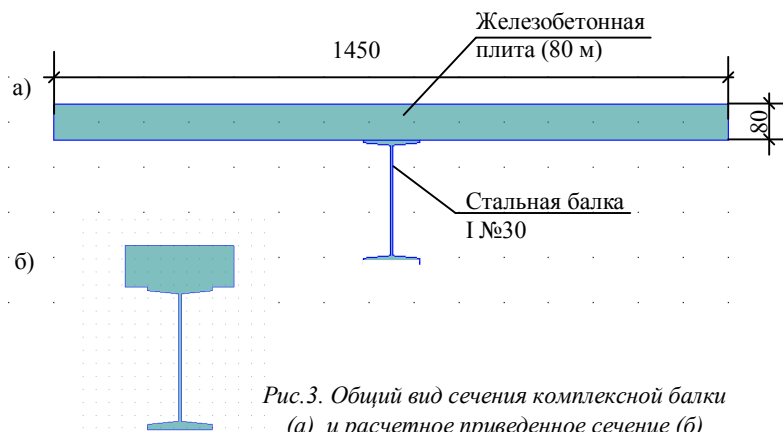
Общий вид сечения комплексной балки (а) и расчетное приведенное сечение (б)
